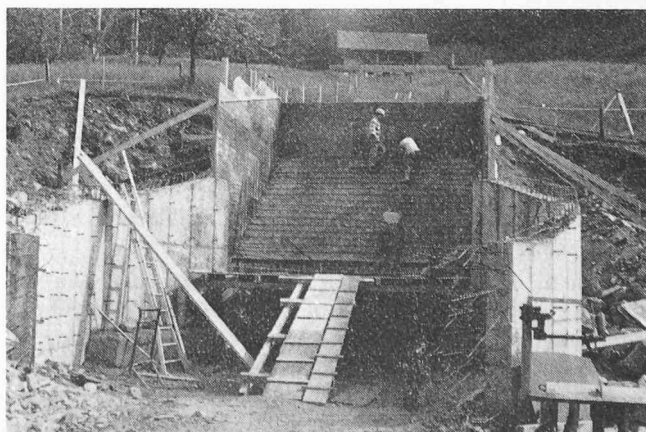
Erste Phase der Schachterstellung: Vom biegesteifen Schachtansatz (BSA) des Schachtes 14 ist hier ein segmentartiger Teil betoniert. Bergseits wird der Schachtaufbau armiert (Aufnahme: D. J. Bänziger, 2. 6. 1977)
